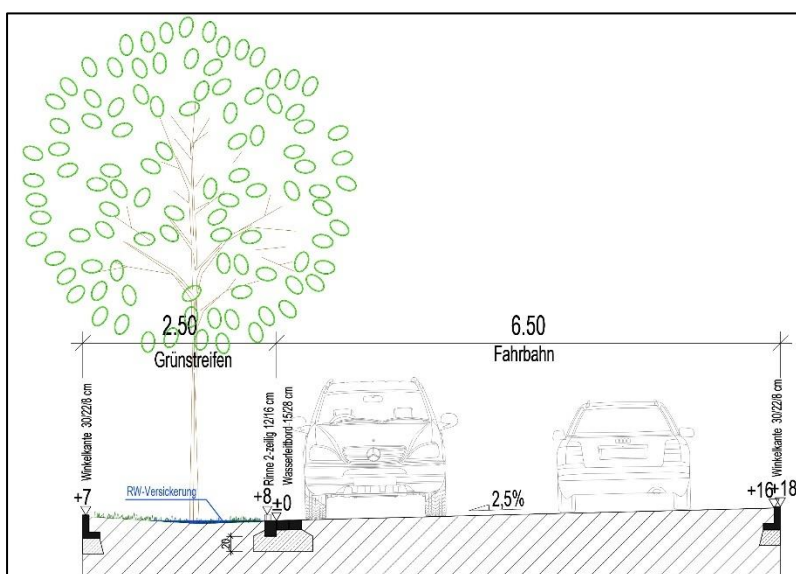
Regelquerschnitt Planstraße A und D (Ibak Ingenieure, Senden - Mai 2025)
